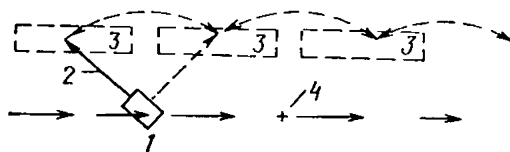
Схема передвижения копра при перемещении свай на площадке
